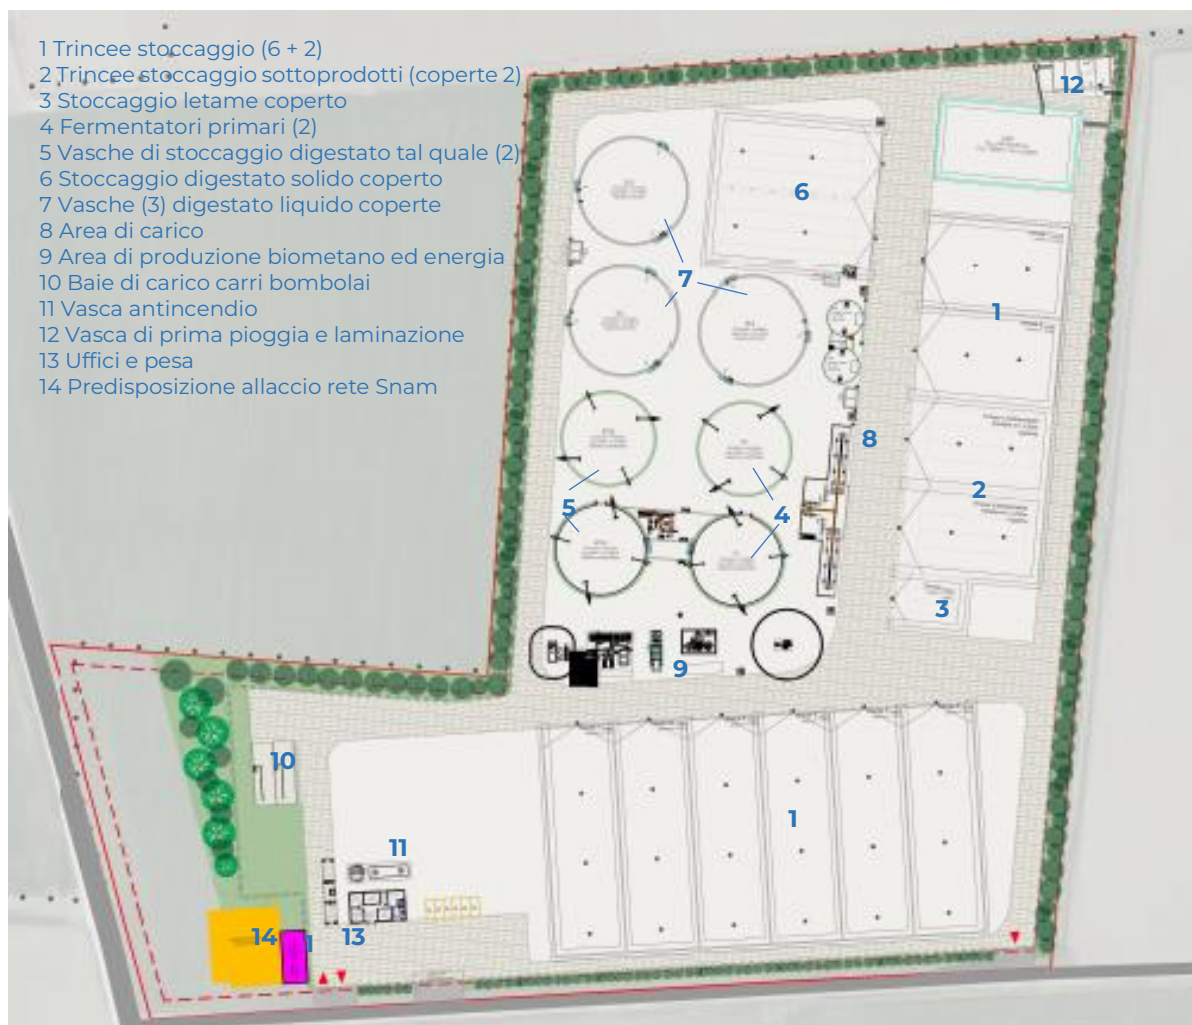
LAYOUT GENERALE DELL'IMPIANTO
